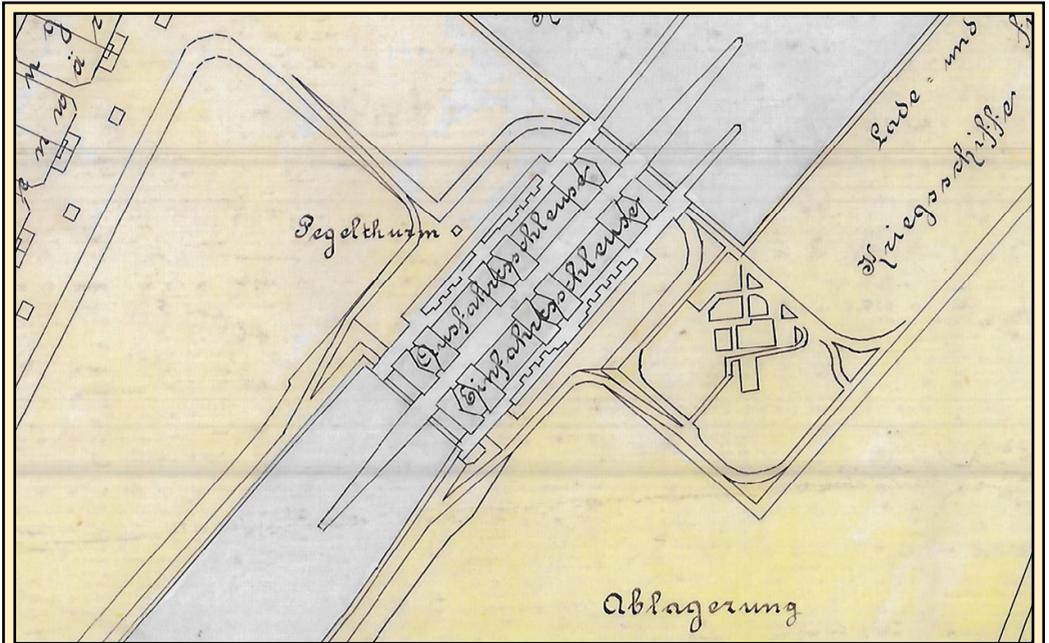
Lageplan mit Einfahrts- und Ausfahrtschleuse.
